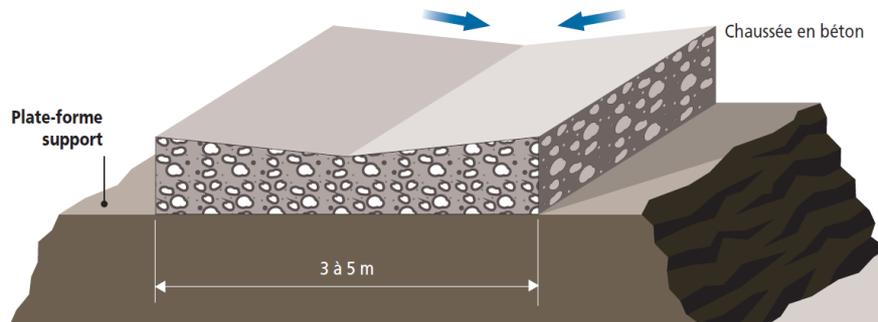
Chaussée à écoulement latéral, profil en V (Source : Cimbéton)
